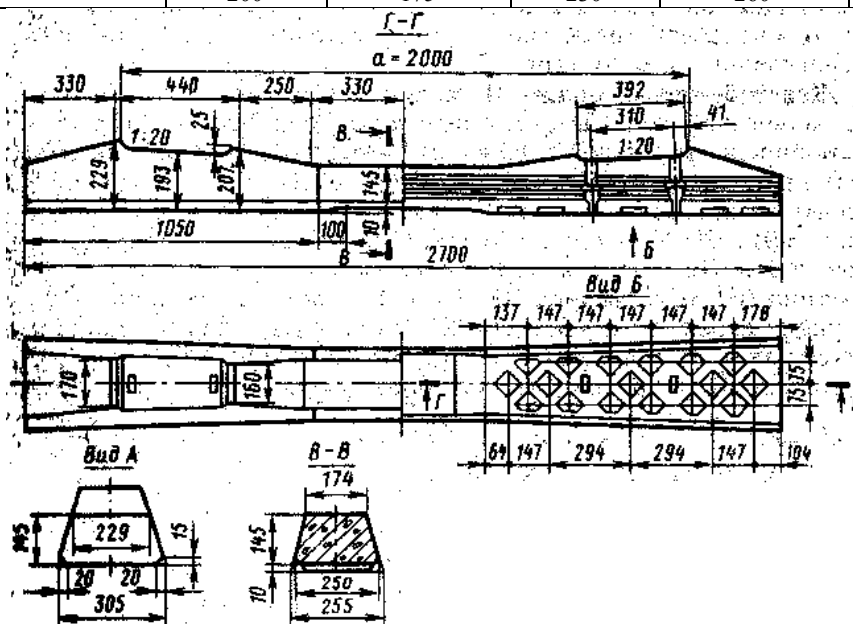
Предварительно напряженные железобетонные шпалы типа Ш1-1.
